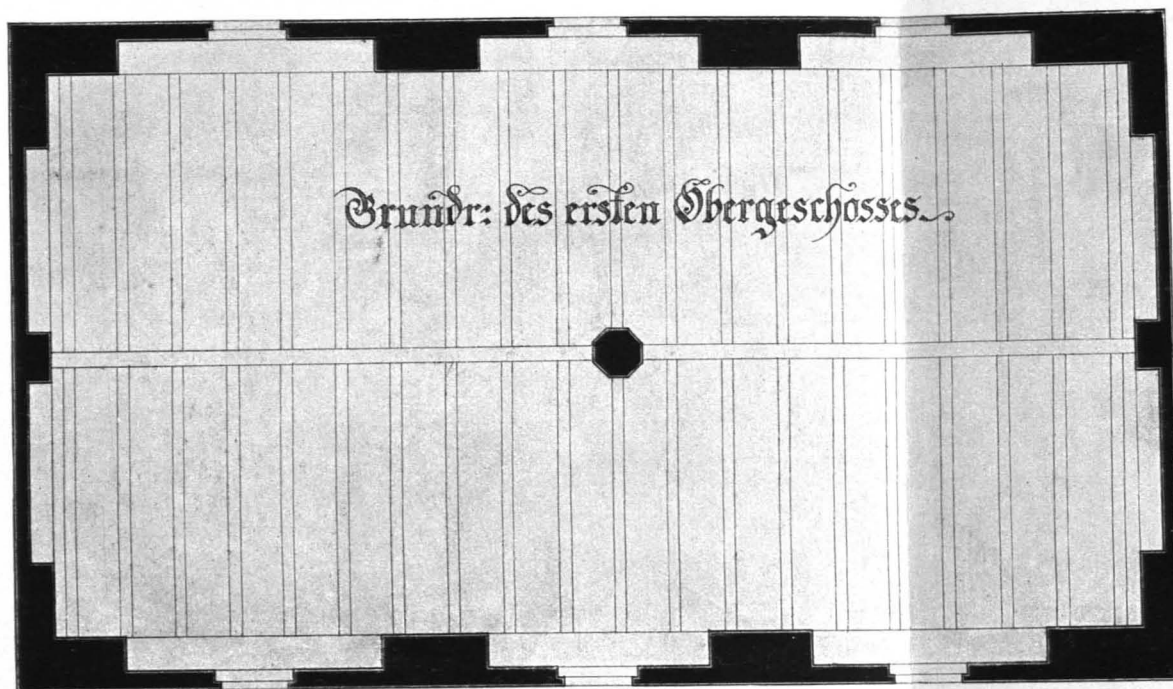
Kilb Nr. 5, Grundriß (S. 96)
